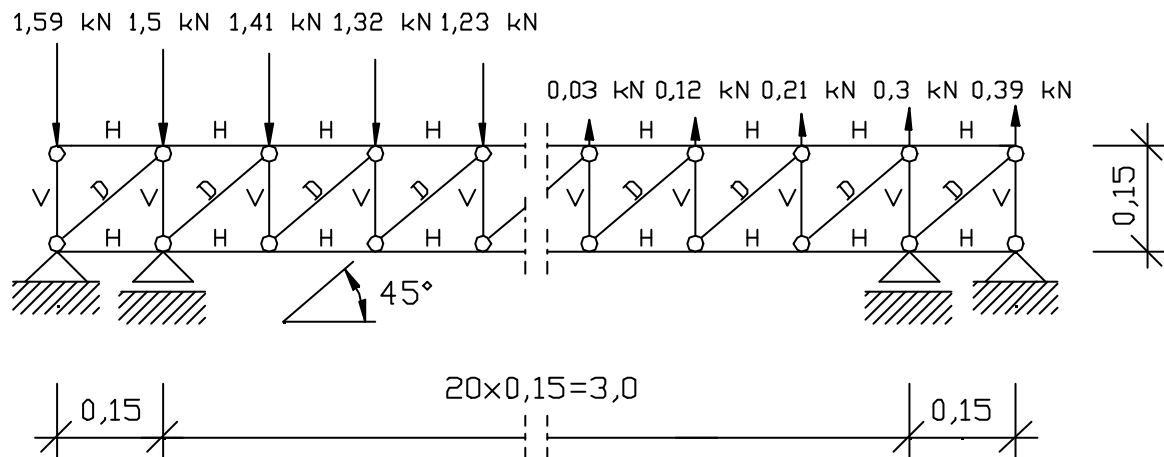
Ersatzmodell mit Stabnummerierung für Brettlagenholz mit diagonaler Struktur
